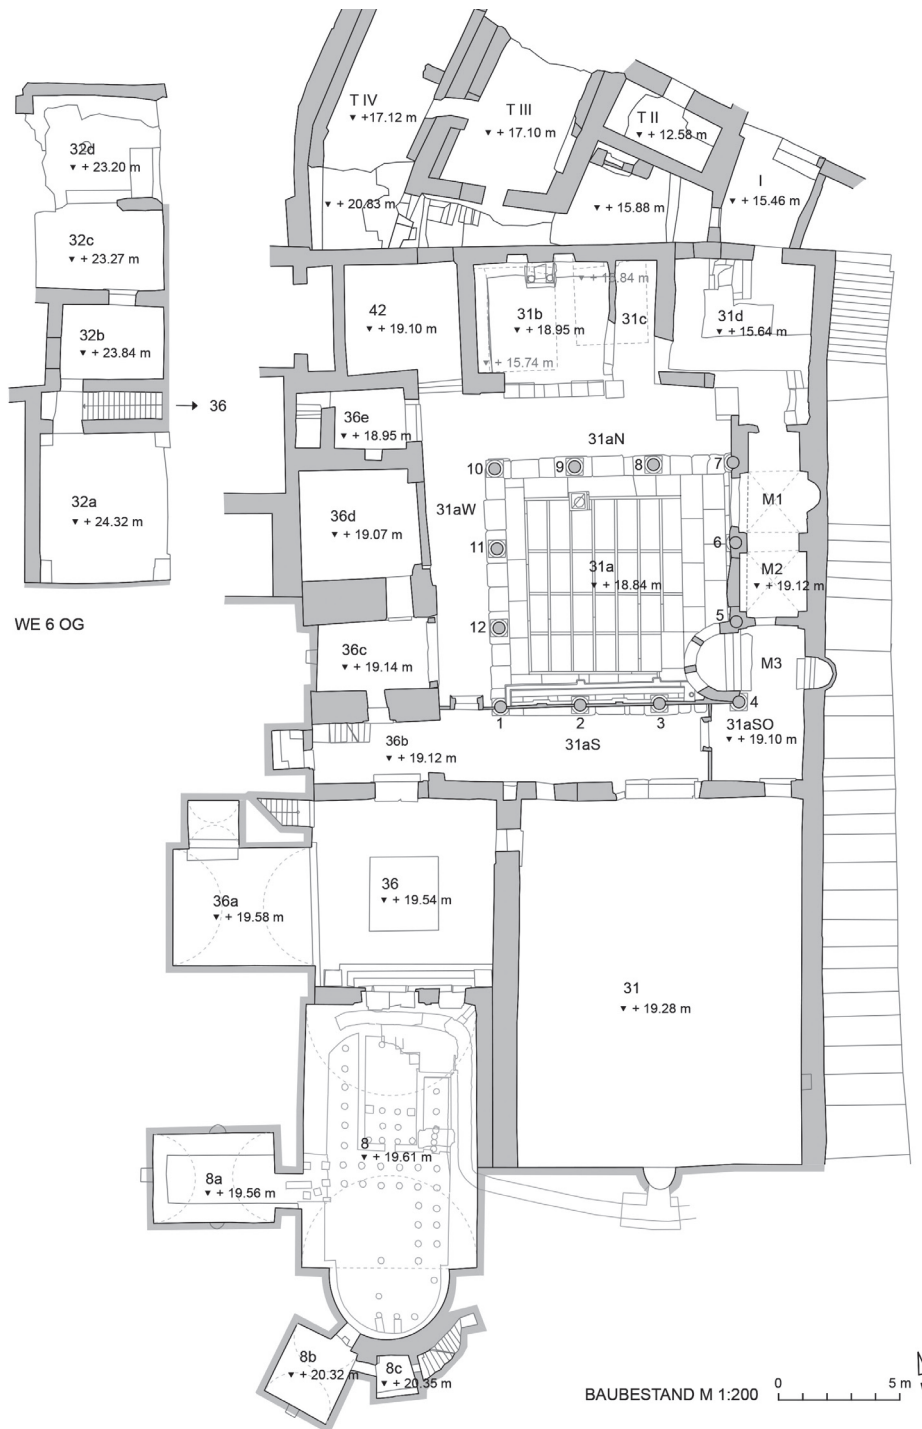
Plan der Wohneinheit (WE) 6, Bestandsplan.
